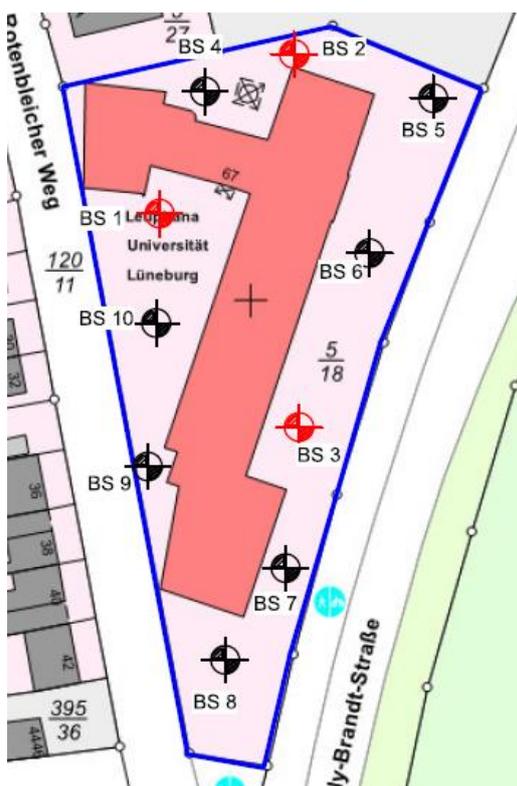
Lage der Bohrsondierpunkte (ACK, 27.02.2019)
